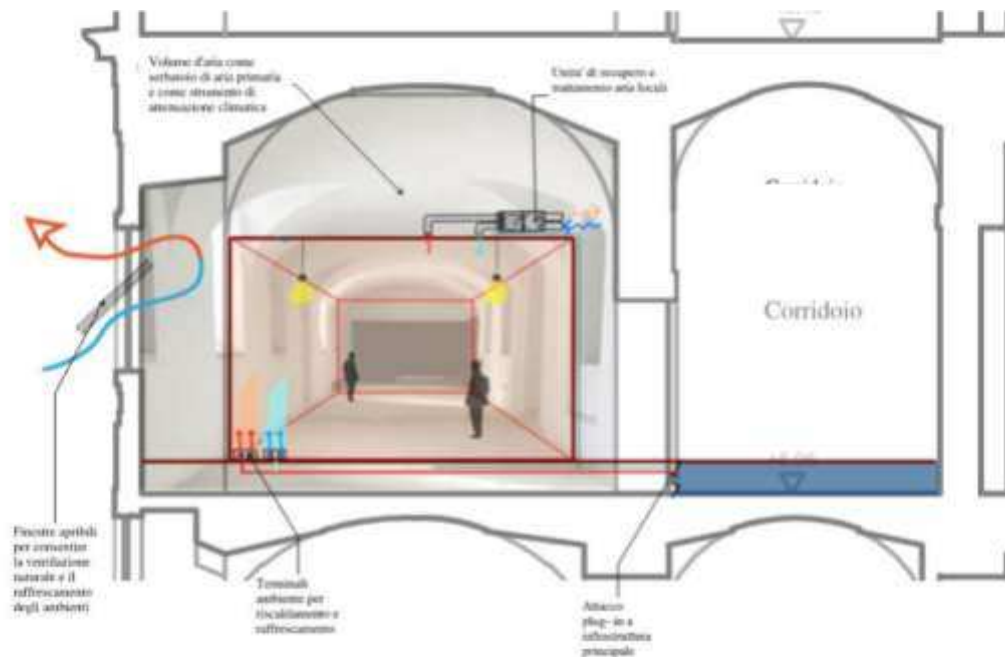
Box in box, tipo 2: Riscaldamento e raffrescamento a pavimento e unità di recupero di calore locale
